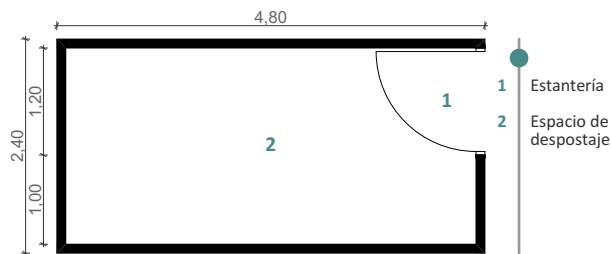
Planta cuarto de despostaje. Fuente: Autores.
